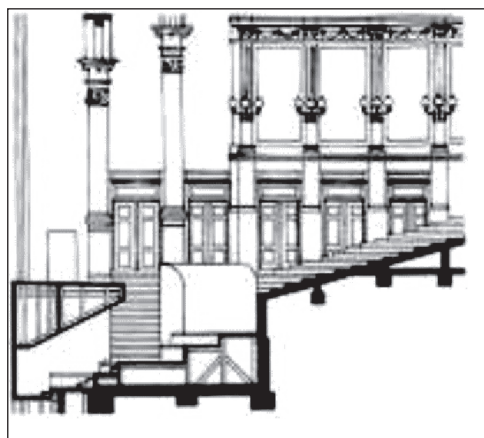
Festspielhaus di Bayreuth. Sezione assonometrica, particolare dell'articolazione strutturale del golfo mistico.
